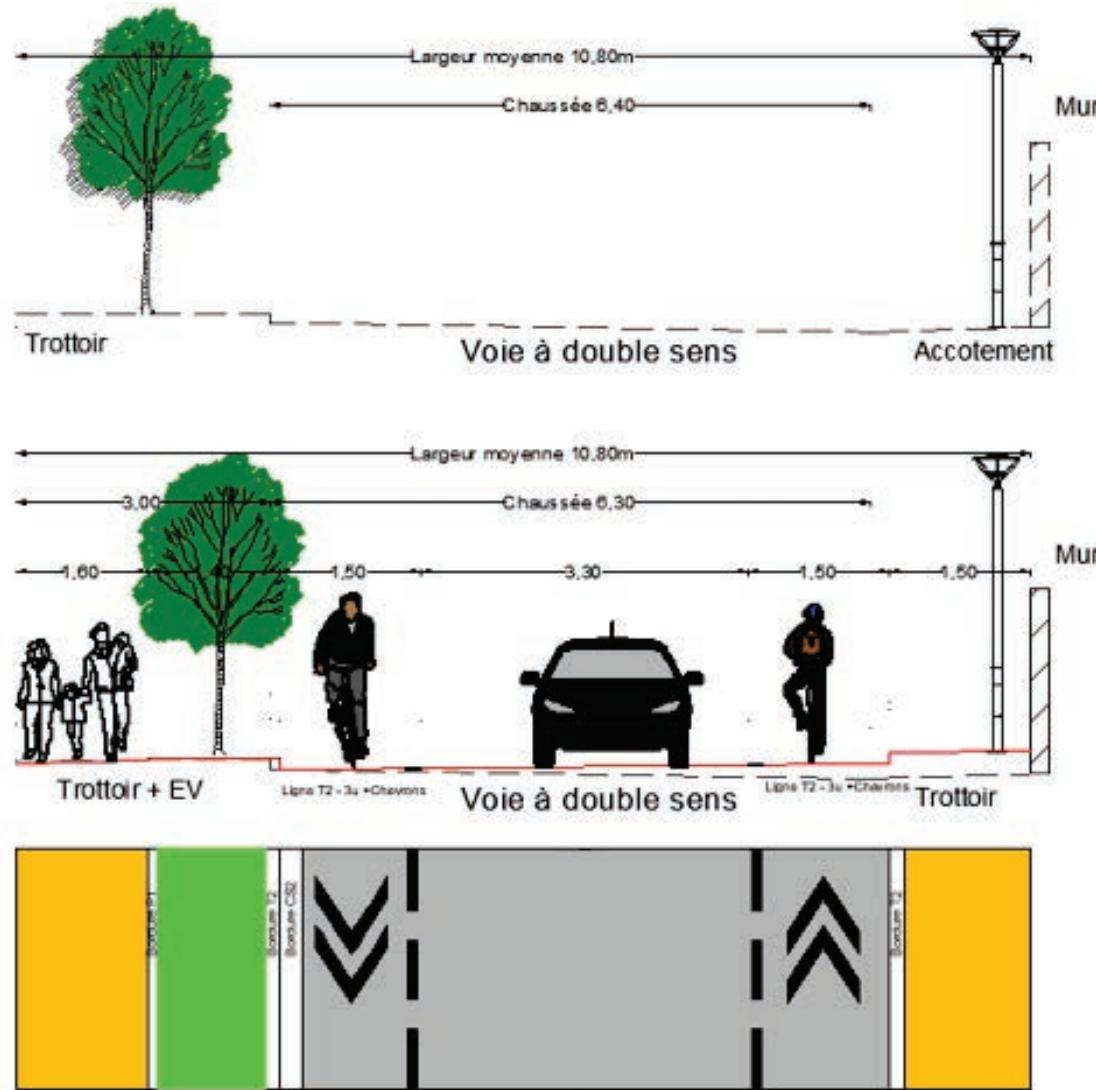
Vue en coupe de la chaussée à voie centrale banalisée au niveau des Hauts de Solaize
